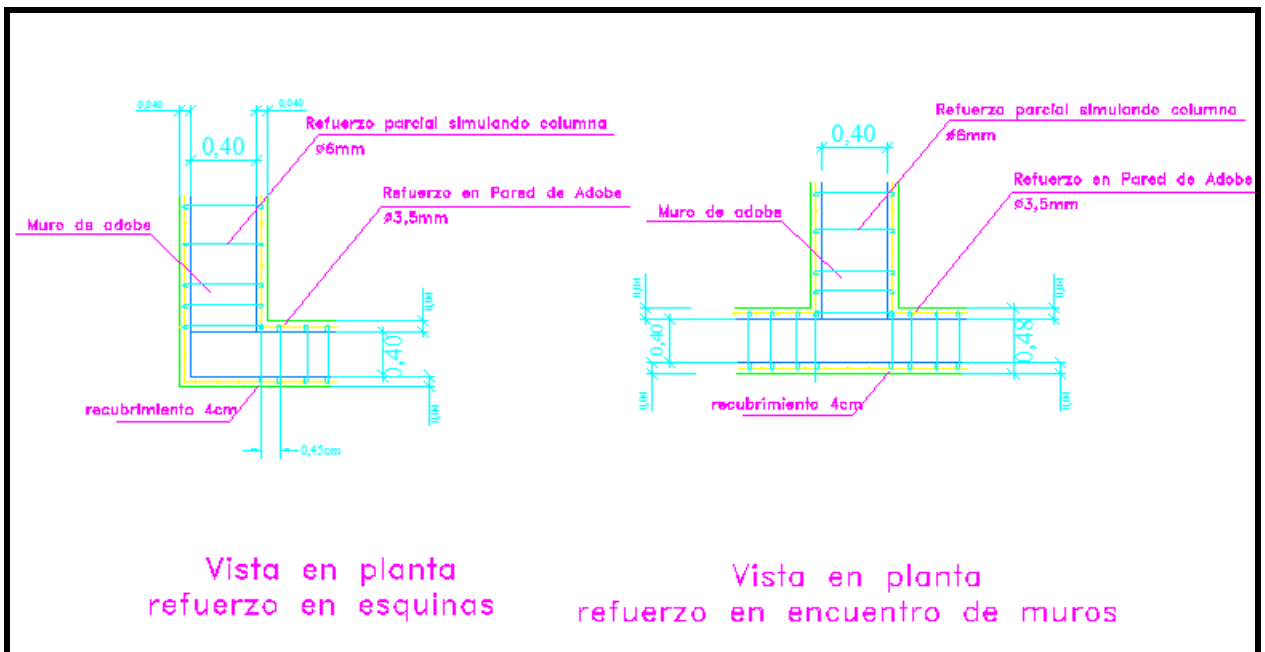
Refuerzo de encuentros en L y en T vista en planta
